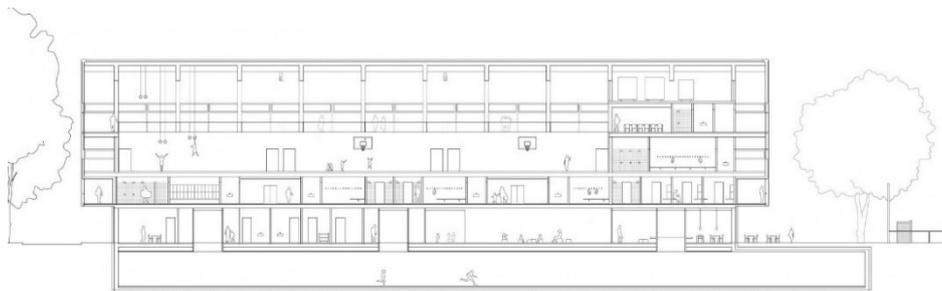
Längsschnitt Siegerprojekt mit Dreifachsporthalle im 2. Obergeschoss
